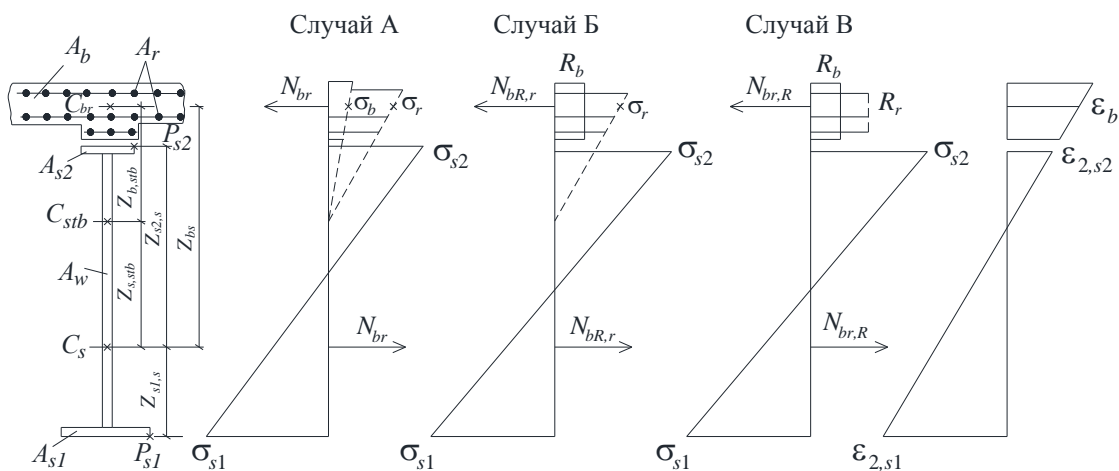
Усилия, напряжения и деформации в сталежелезобетонном поперечном сечении, воспринимающем положительный изгибающий момент
